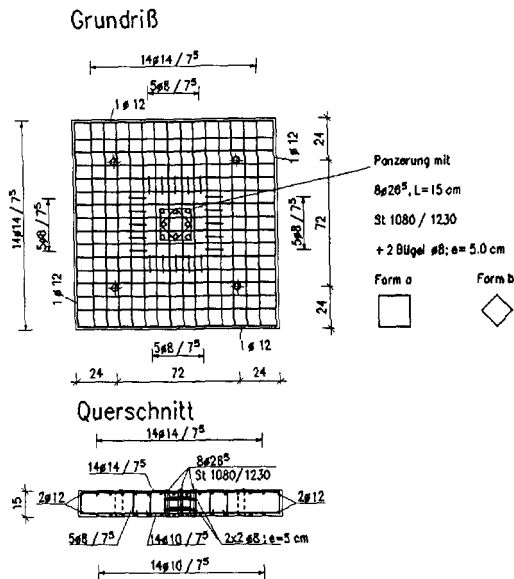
Bewehrungsplan mit Panzerung
